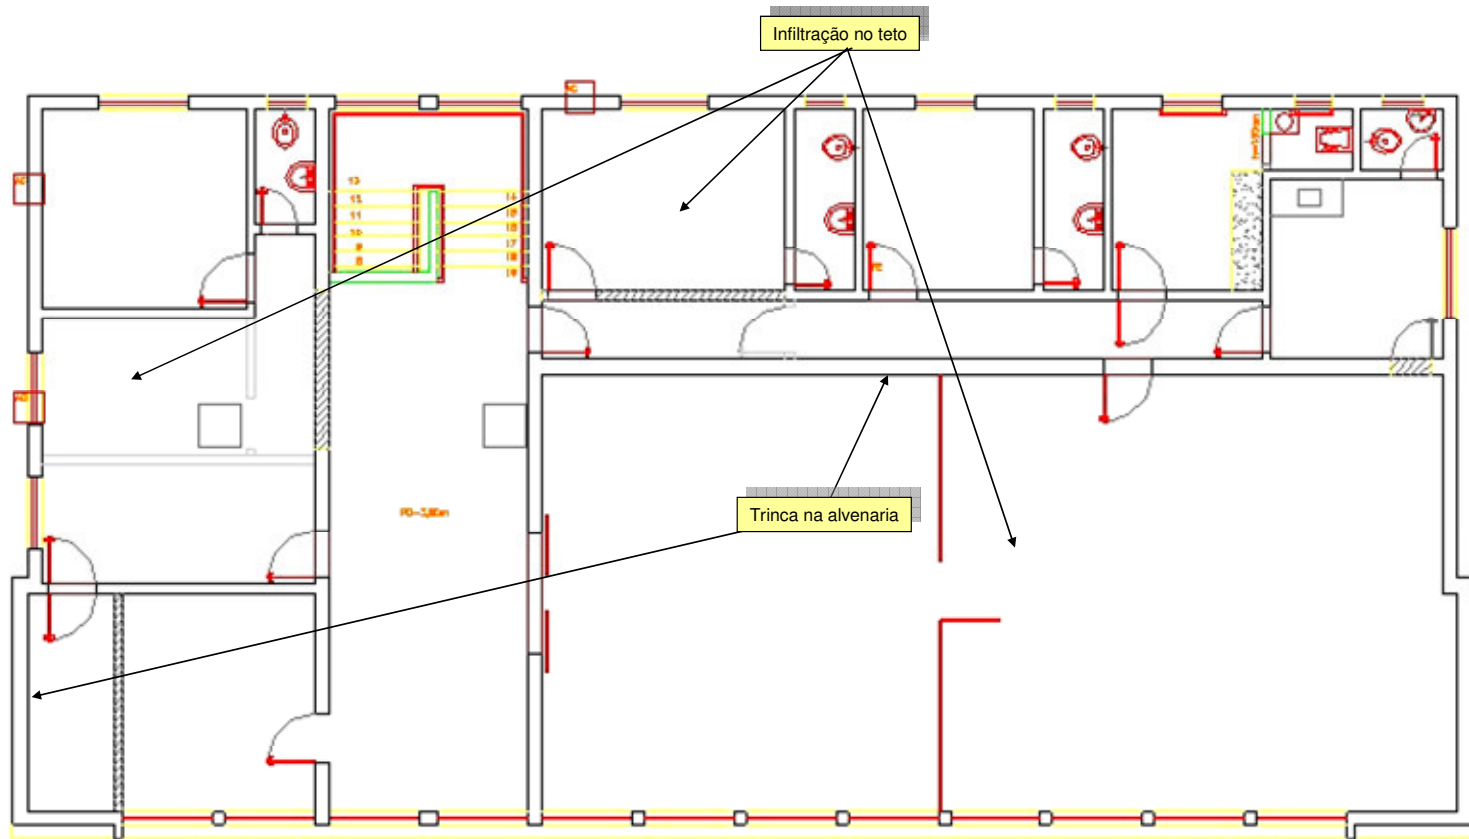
Planta do 2º pavimento e suas patologias.
